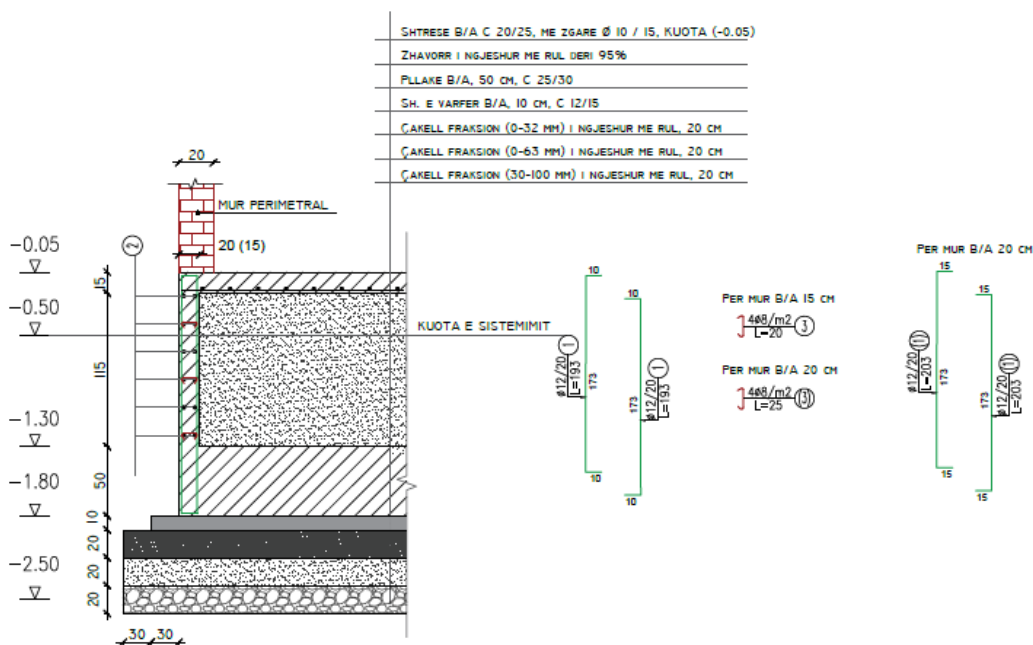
Detaji i themelit dhe mureve perimetrare B/A
